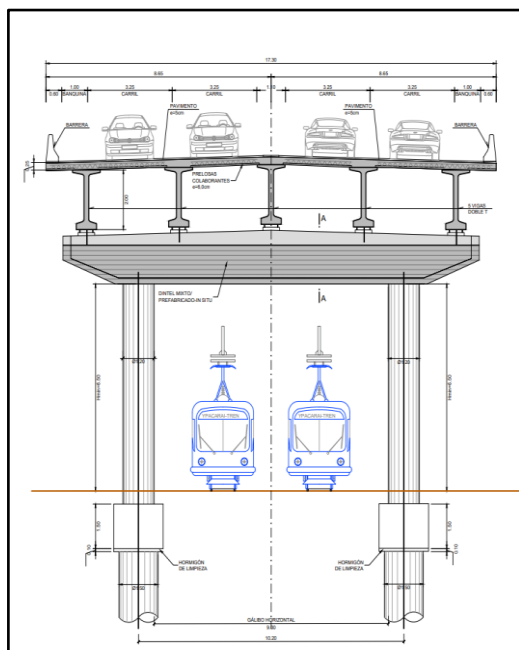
Sección tipo – Estructura PK 27+115 al PK 30+449
